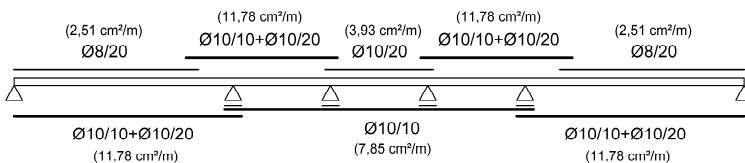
Bewehrungsskizze der erforderlichen Bewehrung zur Begrenzung der Rissbreite bei Überlagerung der Beanspruchungen infolge von Zwang und äußerer Last
